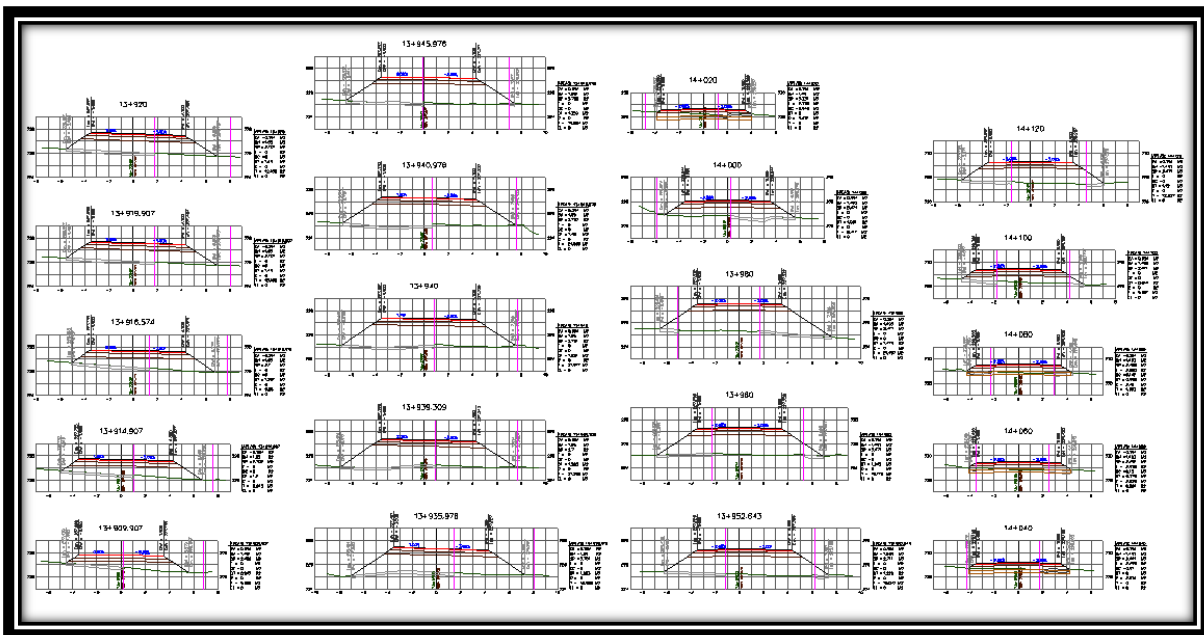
Secciones de construcción del km 13+909.907 al km 14+120.000.
